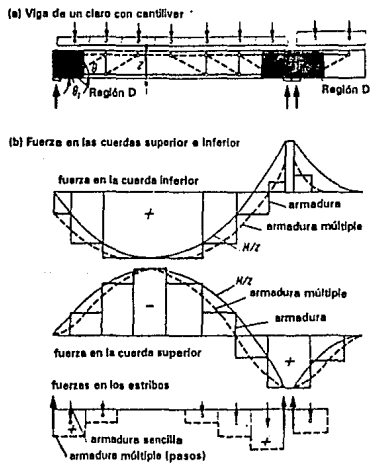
Modelo de la armadura de una viga en cantiliver (Ref. 24)
